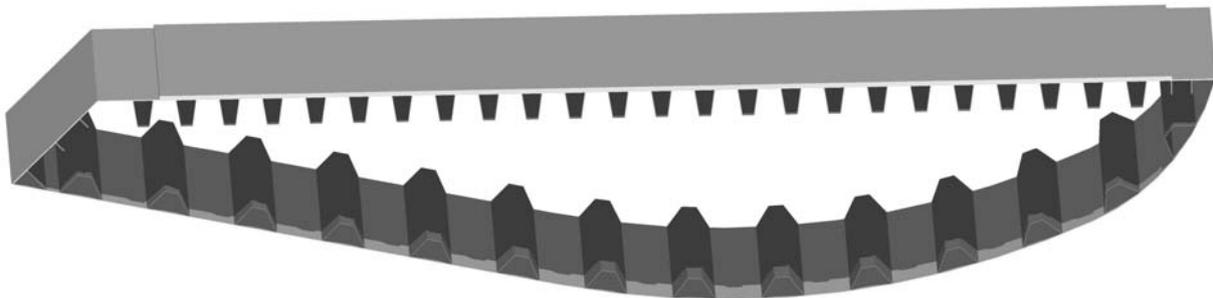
Sezione trasversale tipica dell'impalcato sospeso (stradale).
